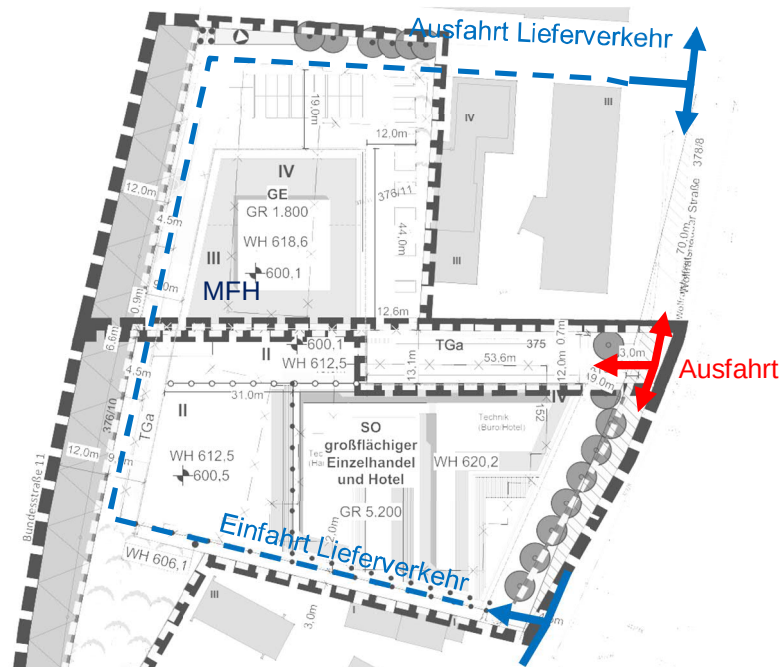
geplante Erschließung Bauvorhaben (Quelle Lageplan: paterre GmbH)
